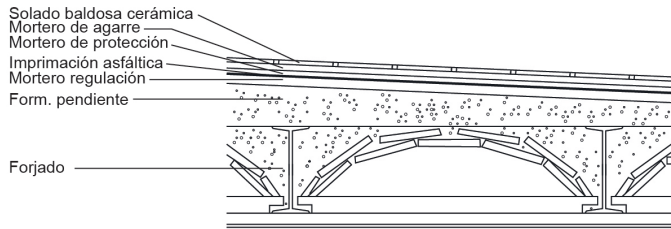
Detalle constructivo de la cubierta ejecutada en la Casa Duclós. Fuente: Elaboración de los autores.
